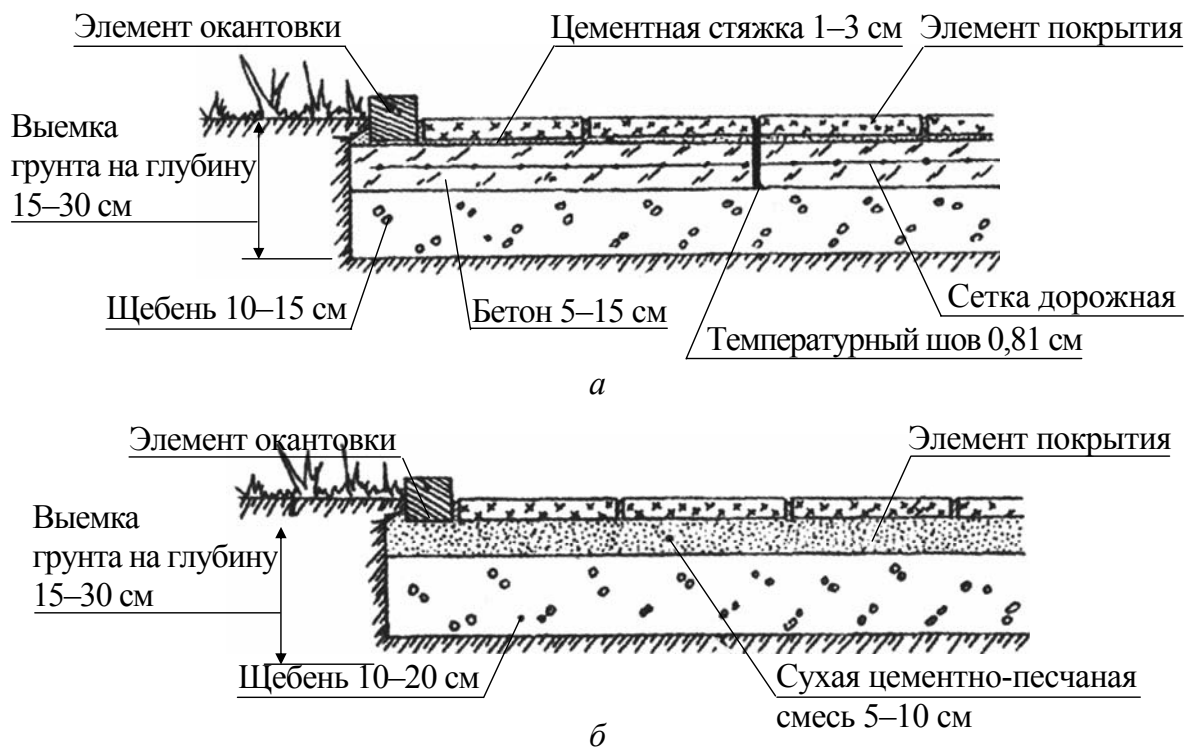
Конструкции садово-парковых дорог из плит:
